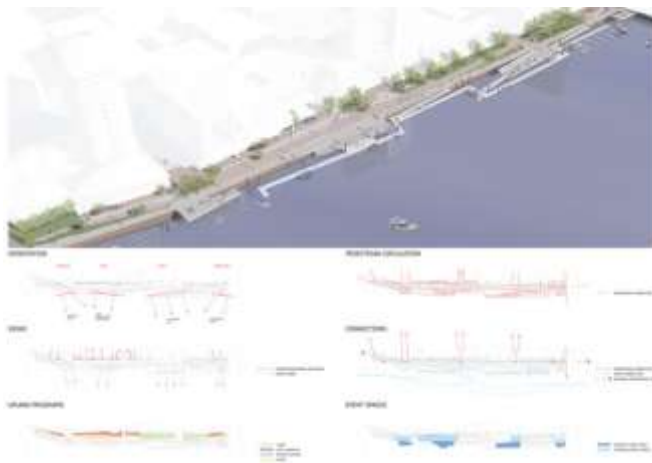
Генеральний план набережної the CityDeck, США [21]
